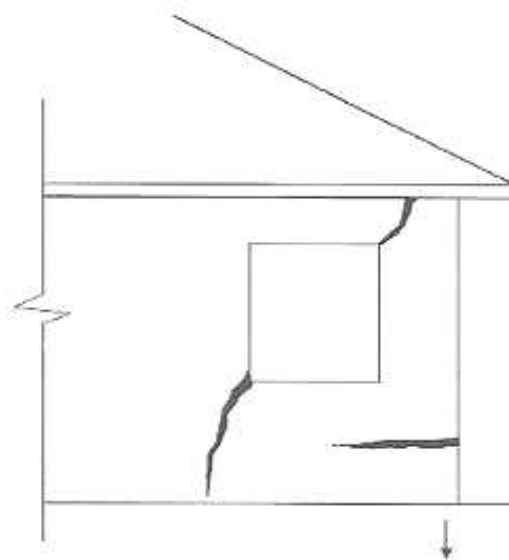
Fissuras em parede portante com recalque na extremidade - CONSOLI; MILITITSKY; SCHINAID, 2008.
